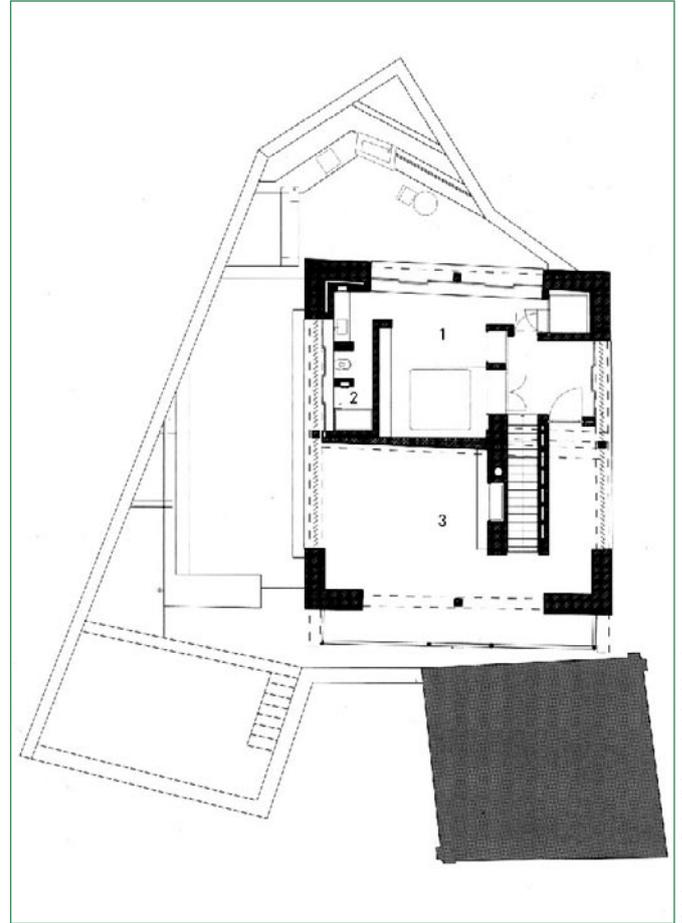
Grundriss 2. Obergeschoss: 1 Schlafen, 2 WC/Dusche, 3 Loggia
